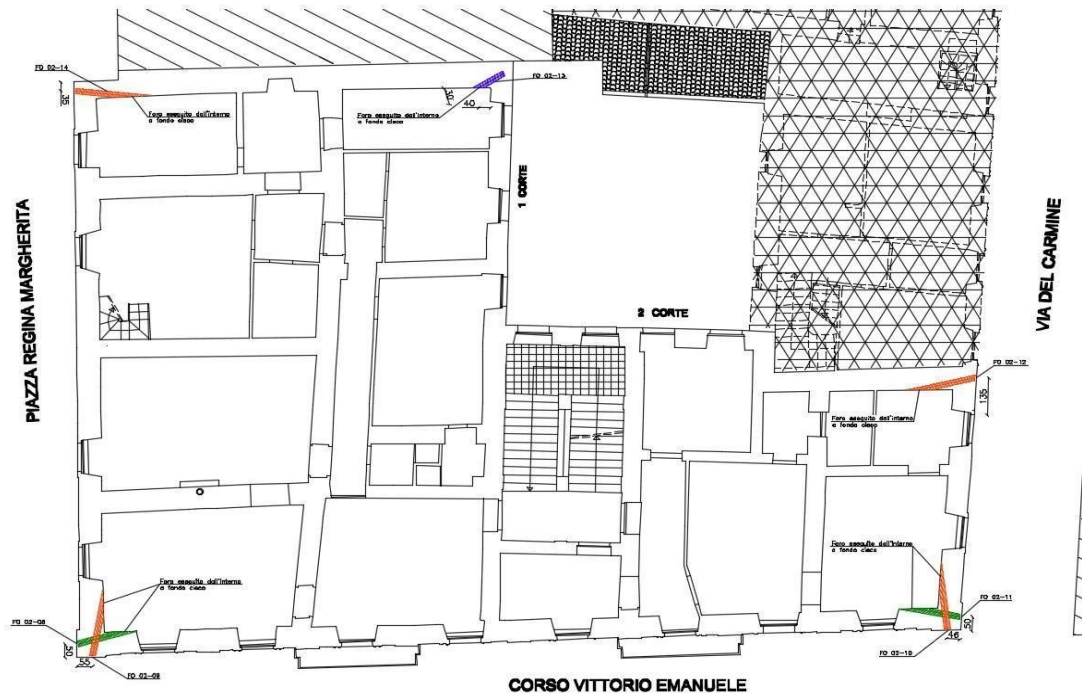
PIANTA PIANO PRIMO - POSIZIONE SENSORI SUI MASCHI MURARI DEL 2° ORDINE MONITORATI
